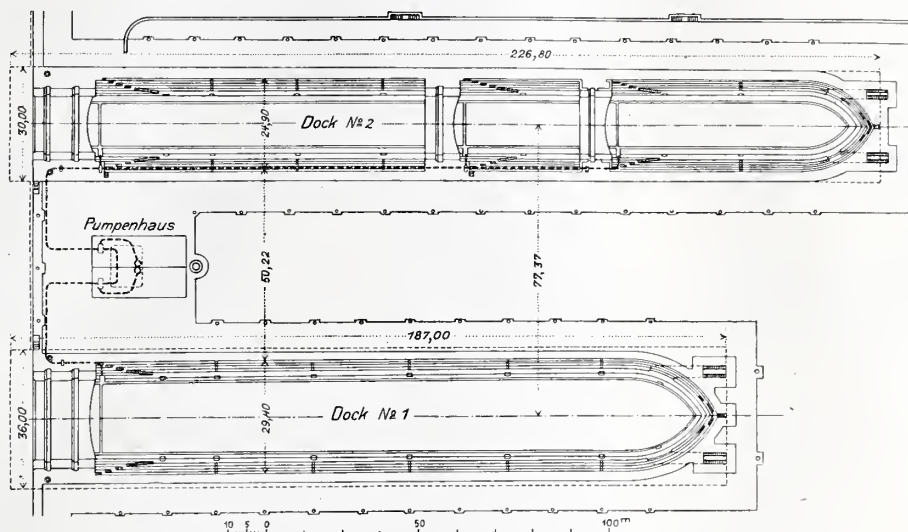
Lageplan der Trockendocks. — Masstab 1 : 2000.
